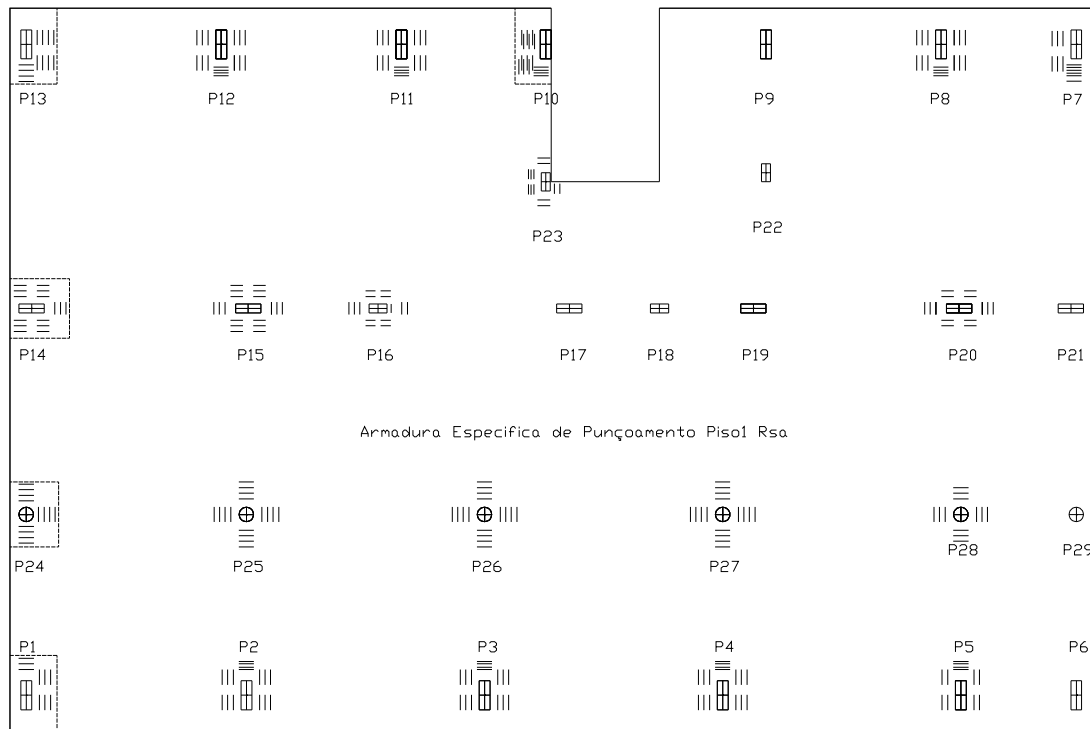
Desenho das armaduras de punçoamento e capitéis piso 1
